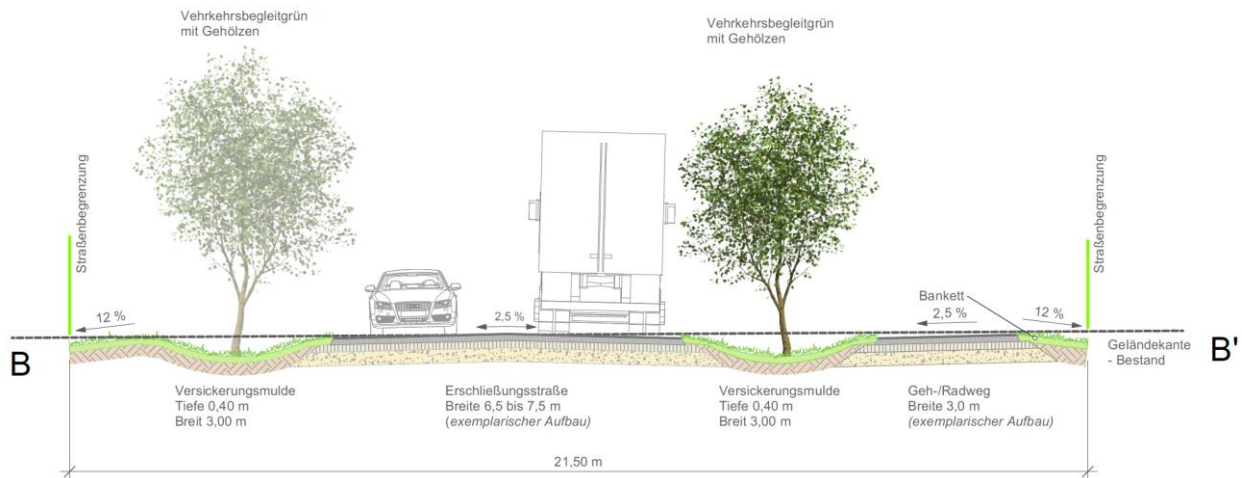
Schemaschnitt Haupterschließungsstraße mit Versickerungsgraben (Quelle: Infraprojekt)
